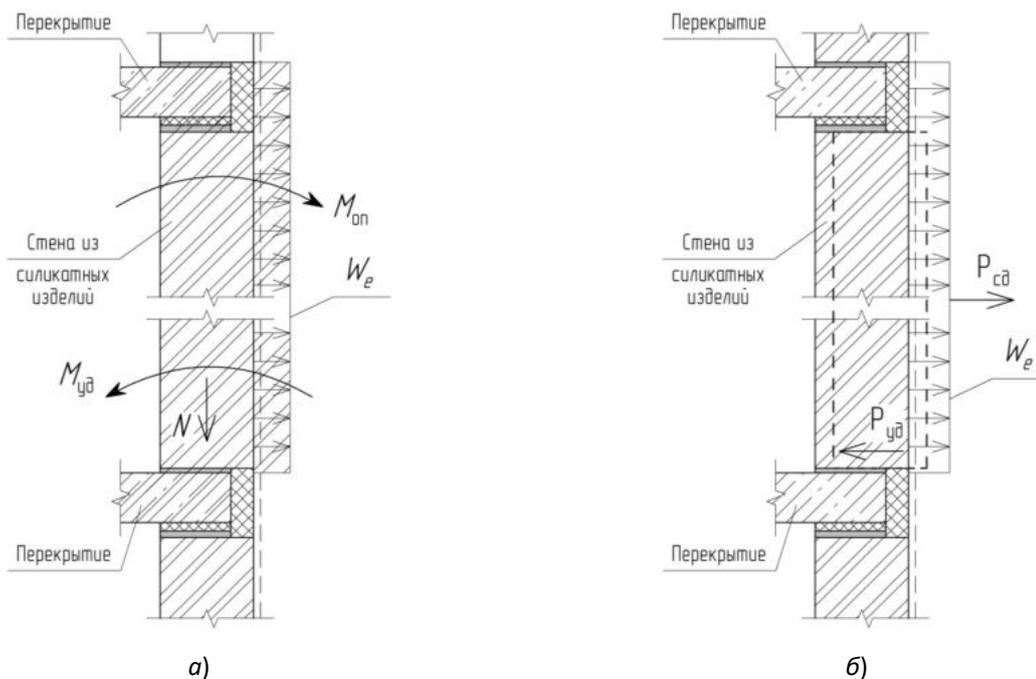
Расчетные схемы поэтажно опертой стены
